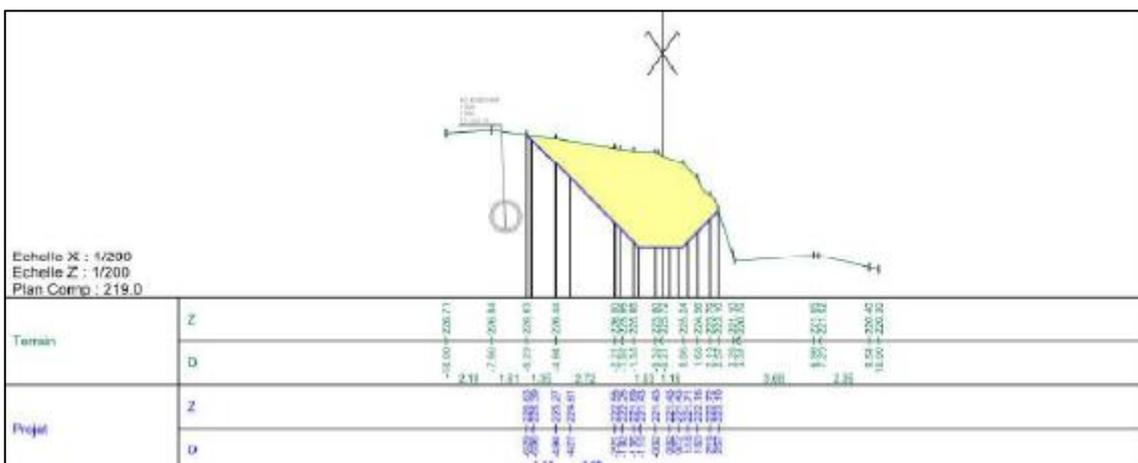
Profil en travers de la dérivation provisoire au droit du raccordement aval, après la passe à poissons
